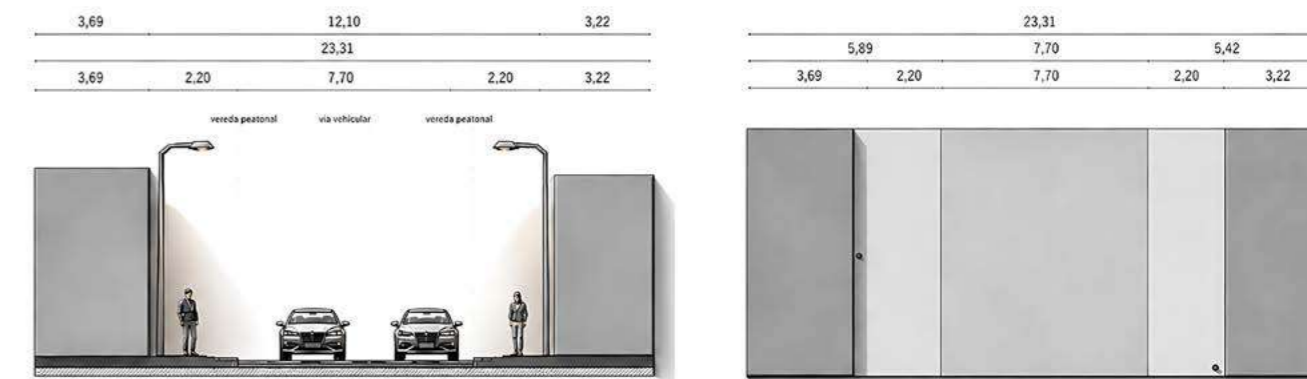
Estado actual de la sección y planta en la calle Tomás Ordóñez. Elaboración propia.
